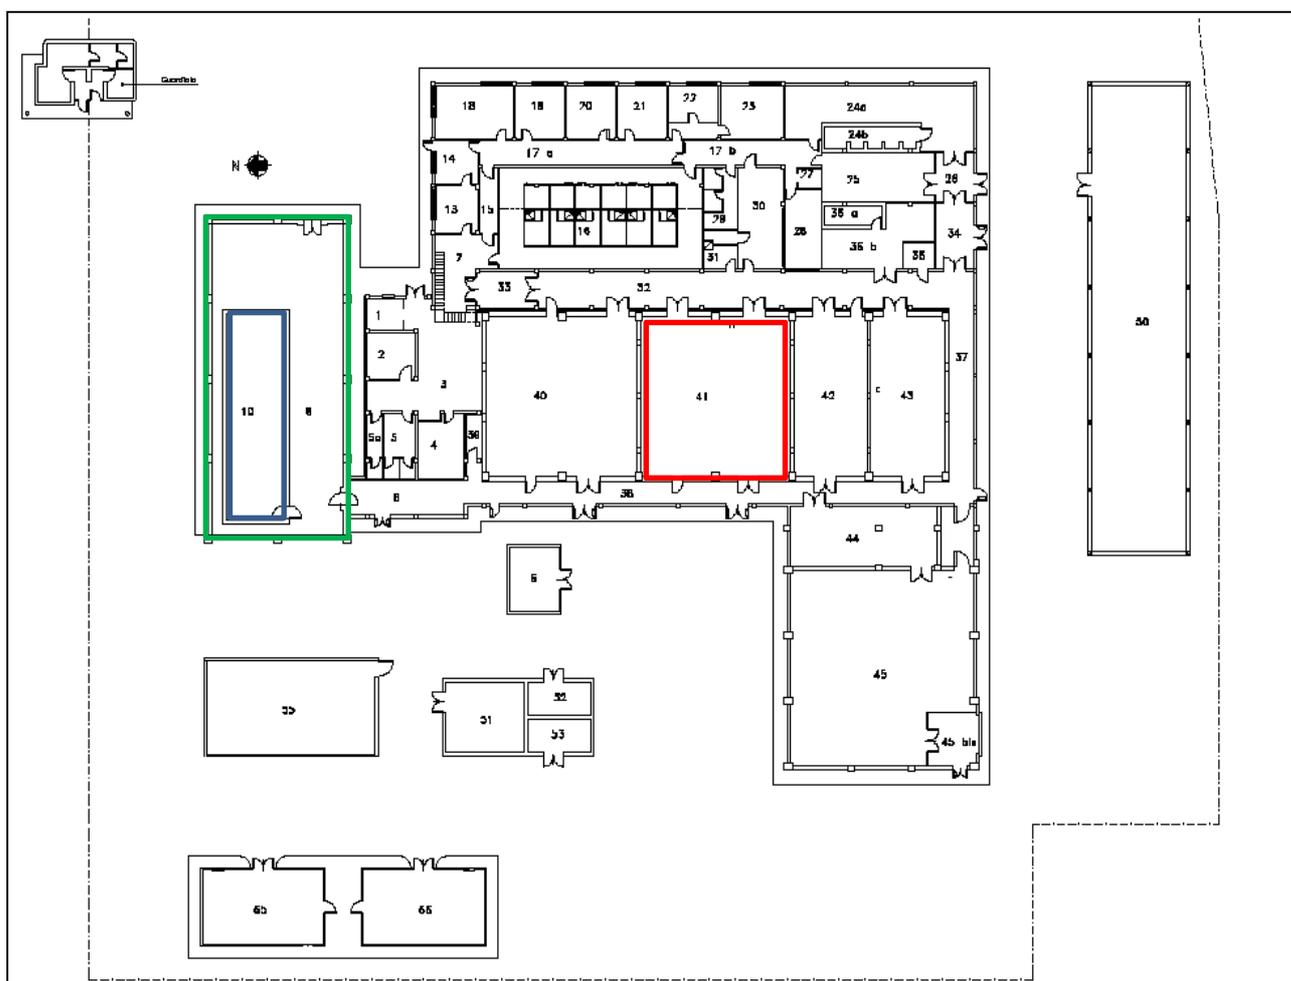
Planimetria IPU – Pianta piano terra: Laboratorio 41 in rosso, in blu il locale 10 e in verde locale 9
